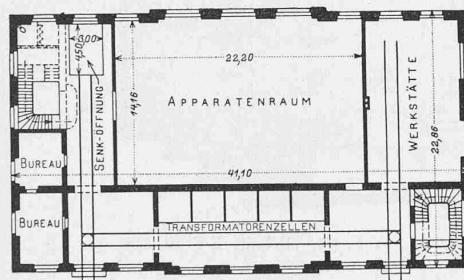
Grundriss vom Obergeschoß der Zentrale. — 1:600.
